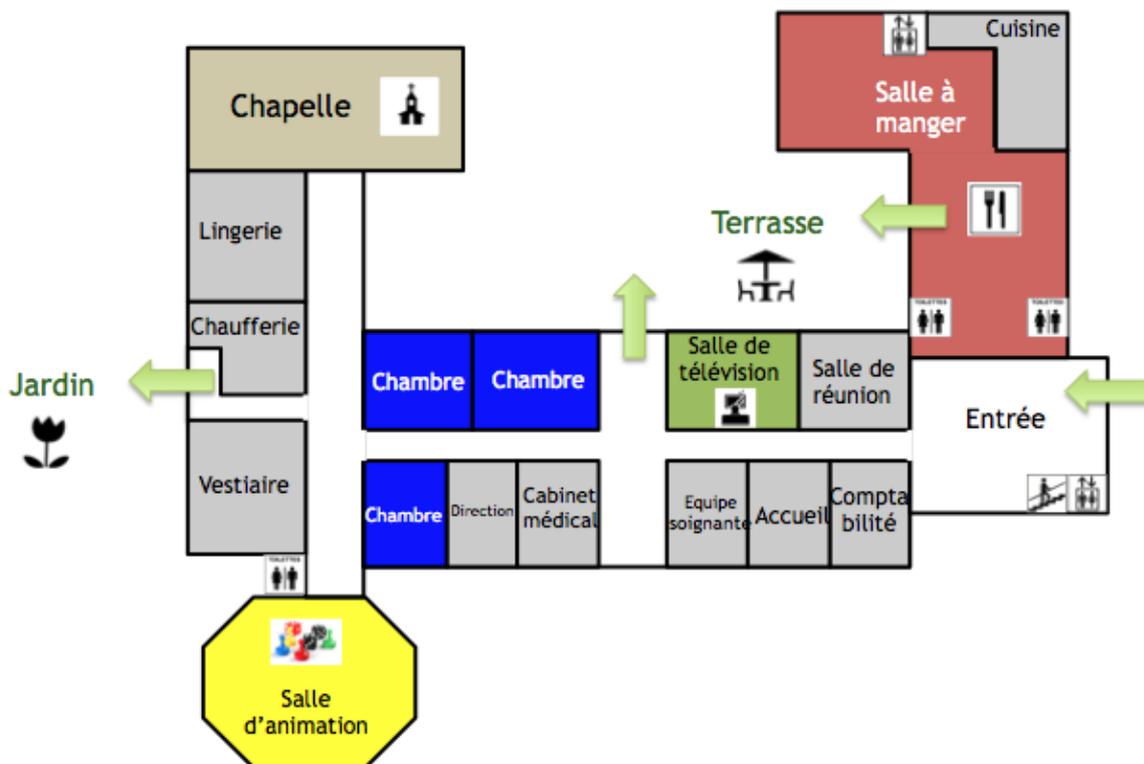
EHPAD Bon Pasteur - Plan simplifié du rez-de-chaussée
